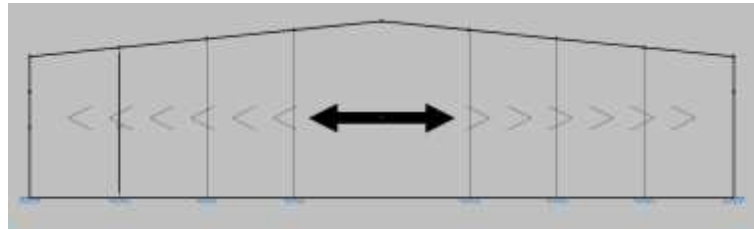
Distribución cargas fachada principal y trasera. Fuente-CYPE
